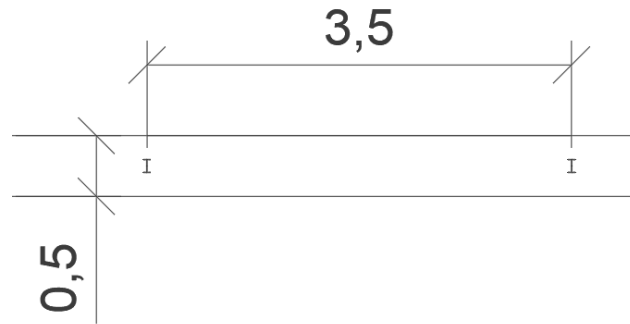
Dimensiones de la posible zapata y separación entre pilares
